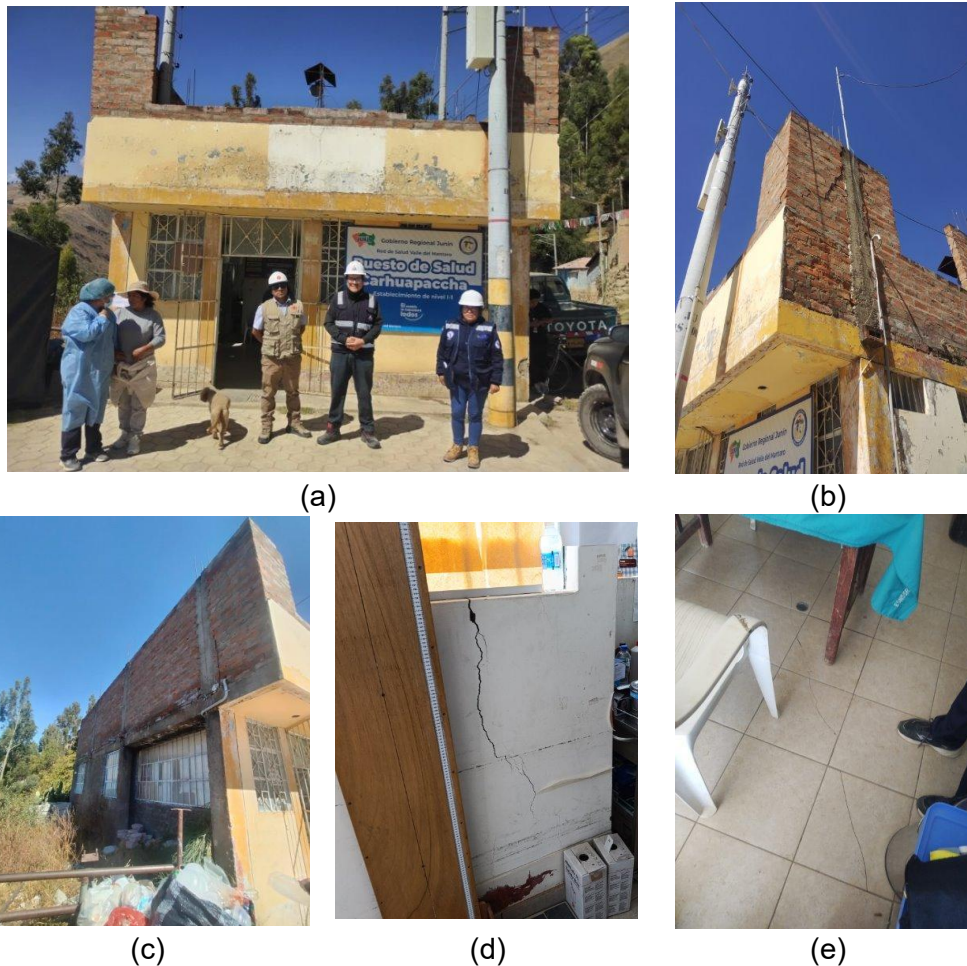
Posta de Salud Carhuapaccha (a) Vista general de la edificación. (b) Segundo nivel parcialmente construido con muros de relleno y arriostramiento limitado. (c) Muro lateral del nivel superior con discontinuidades y condición vulnerable fuera del plano. (d) Fisuración localizada en encuentro de muro y abertura. (e) Fisuración localizada en piso interior.
